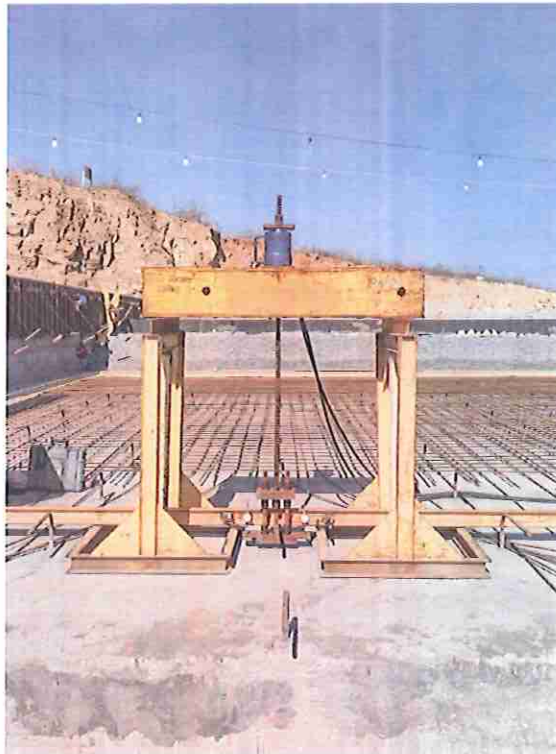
Sistema de reação. Perfil montado sobre cavaletes de apoio.
